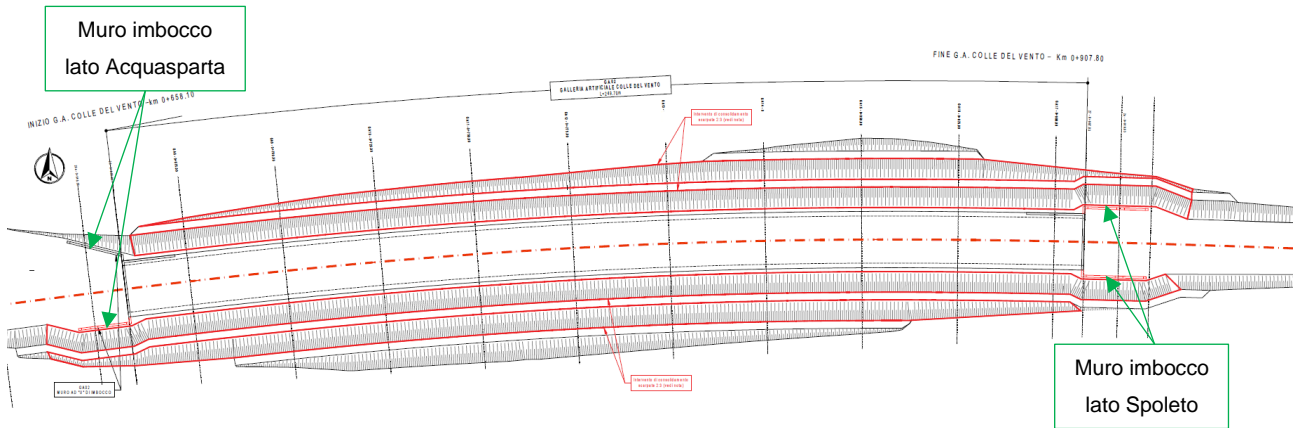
Stralcio planimetrico galleria Colle del Vento.
